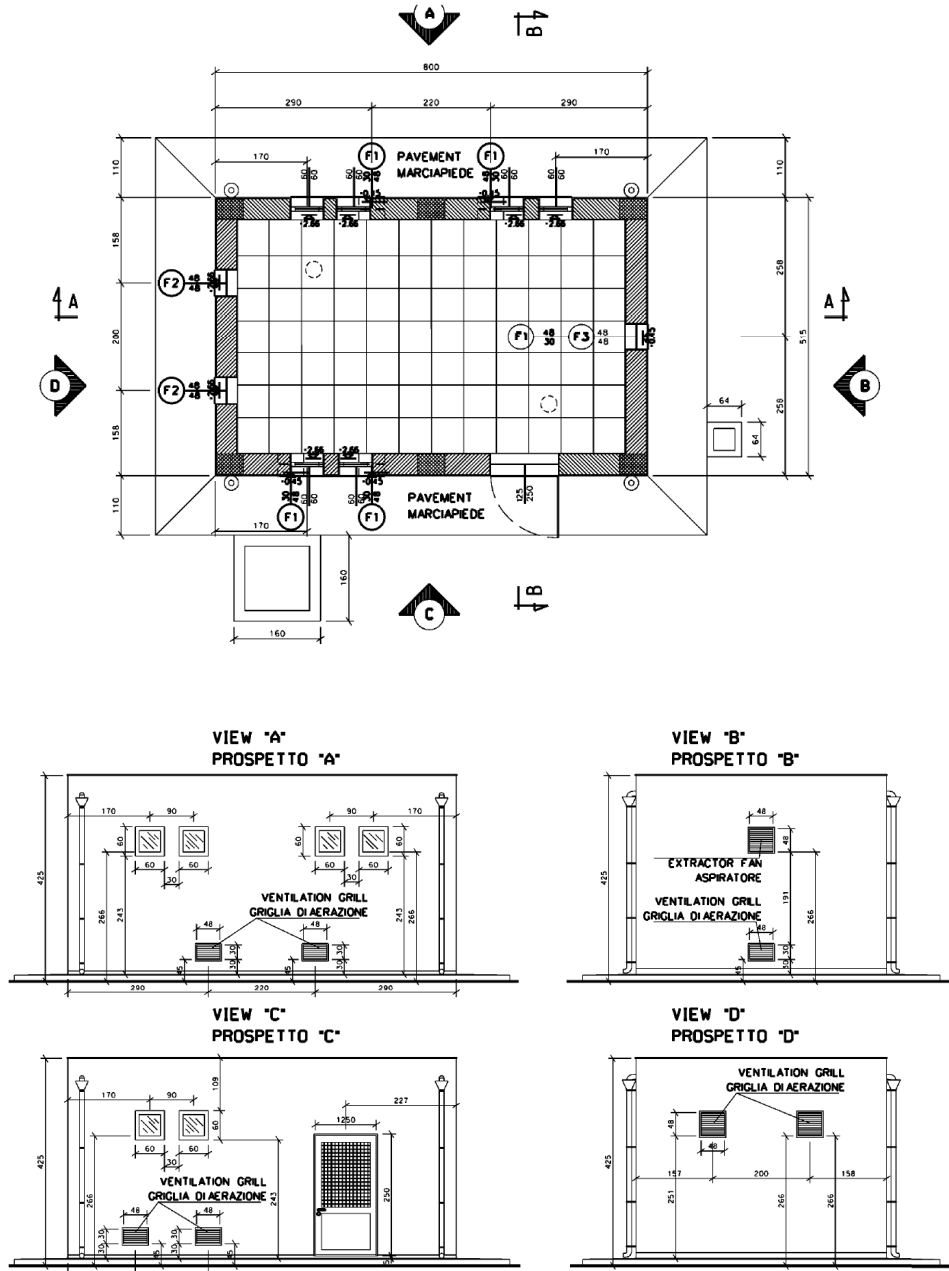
Edificio del controllo elettrico per il terminale di Gela – Pianta e prospetti
